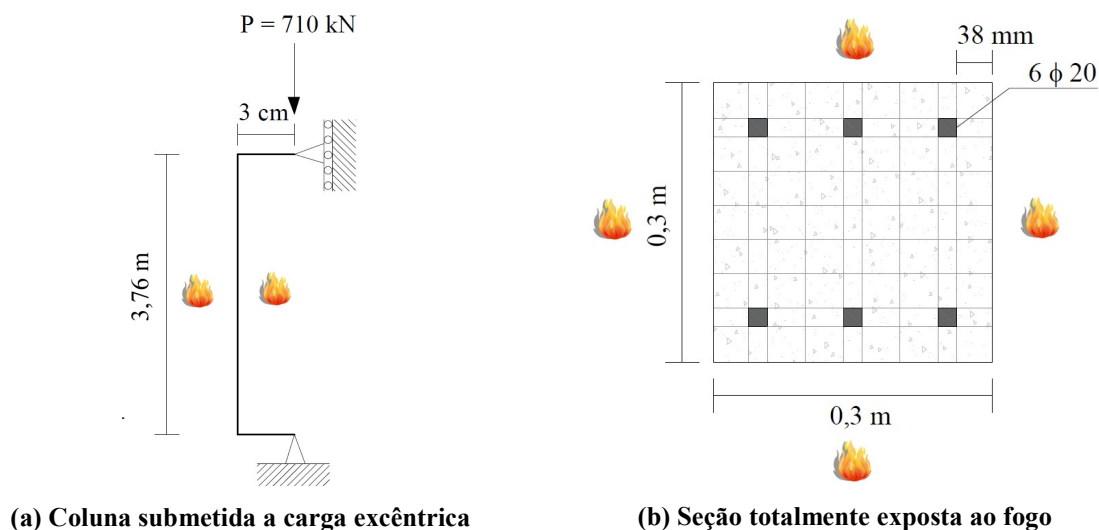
Coluna em concreto armado de seção 30 x 30 cm
